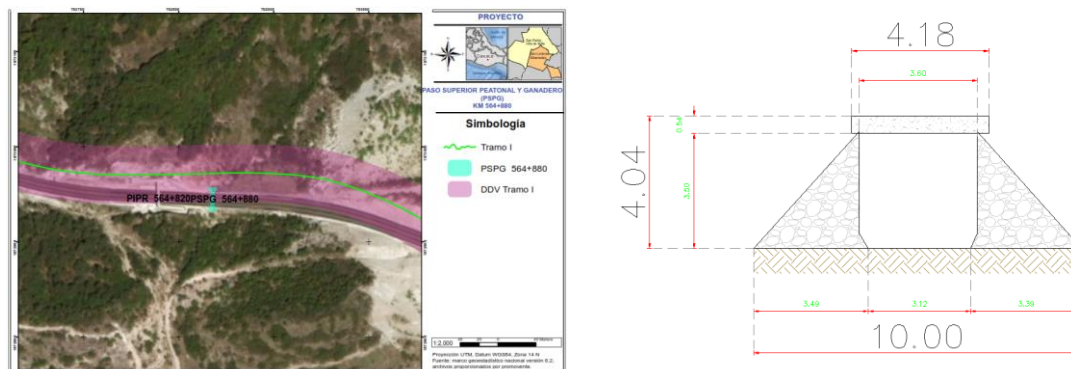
Proyecto en planta y corte transversal del PSPG 564+880.
